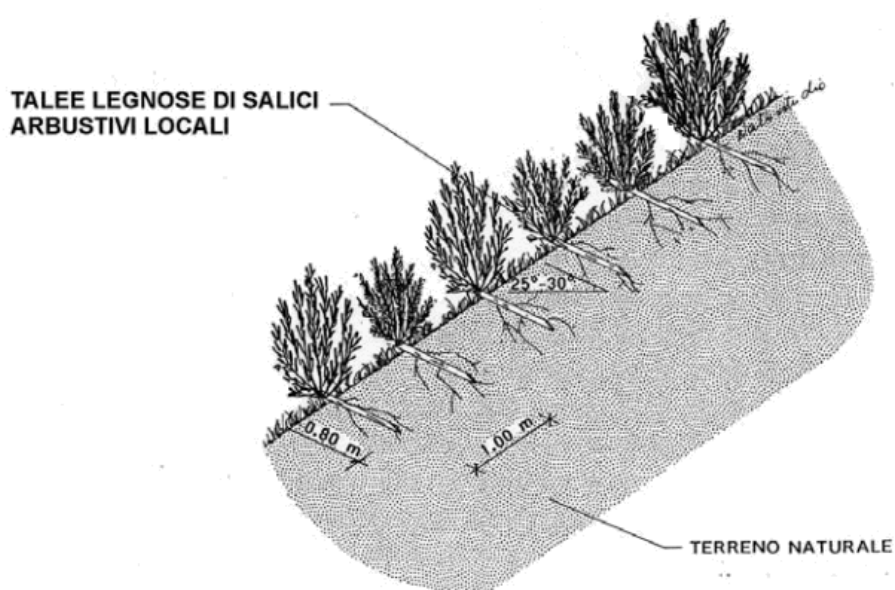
Sezione tipo riportante l'inclinazione, rispetto all'orizzontale, di infissione delle talee
